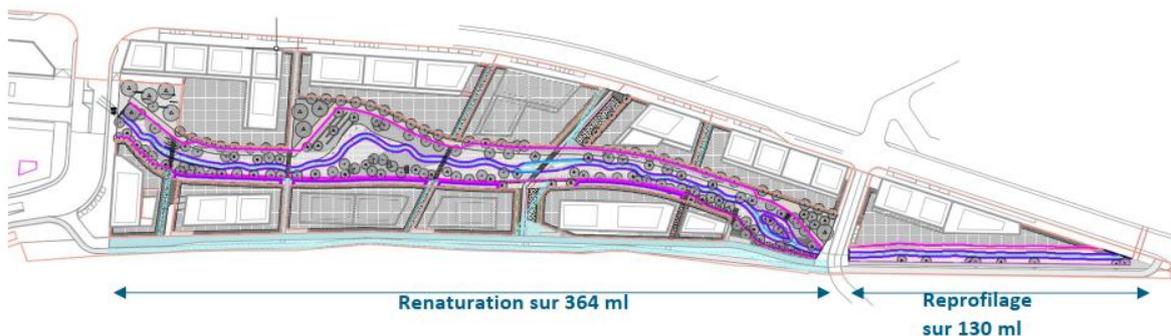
Vue en plan du projet de renaturation de l'Arande au stade AVP
